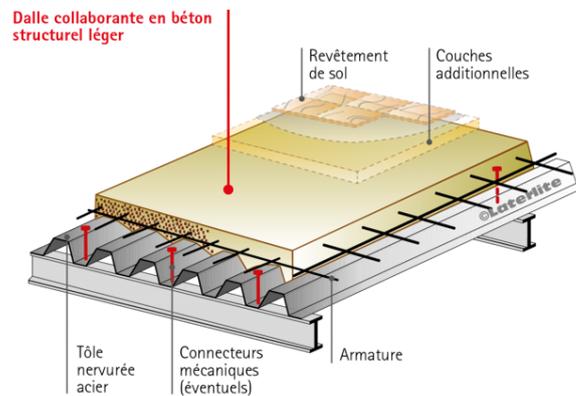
Détail de jonction entre la poutre métallique et la dalle
